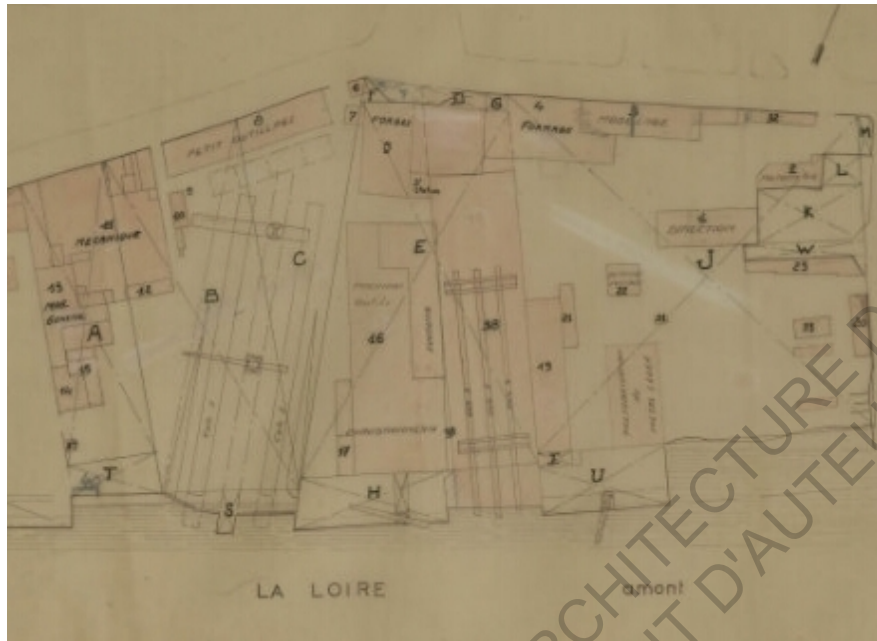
Plan d'ensemble schématique des anciens Chantiers Dubigeon. Ref : MHT
